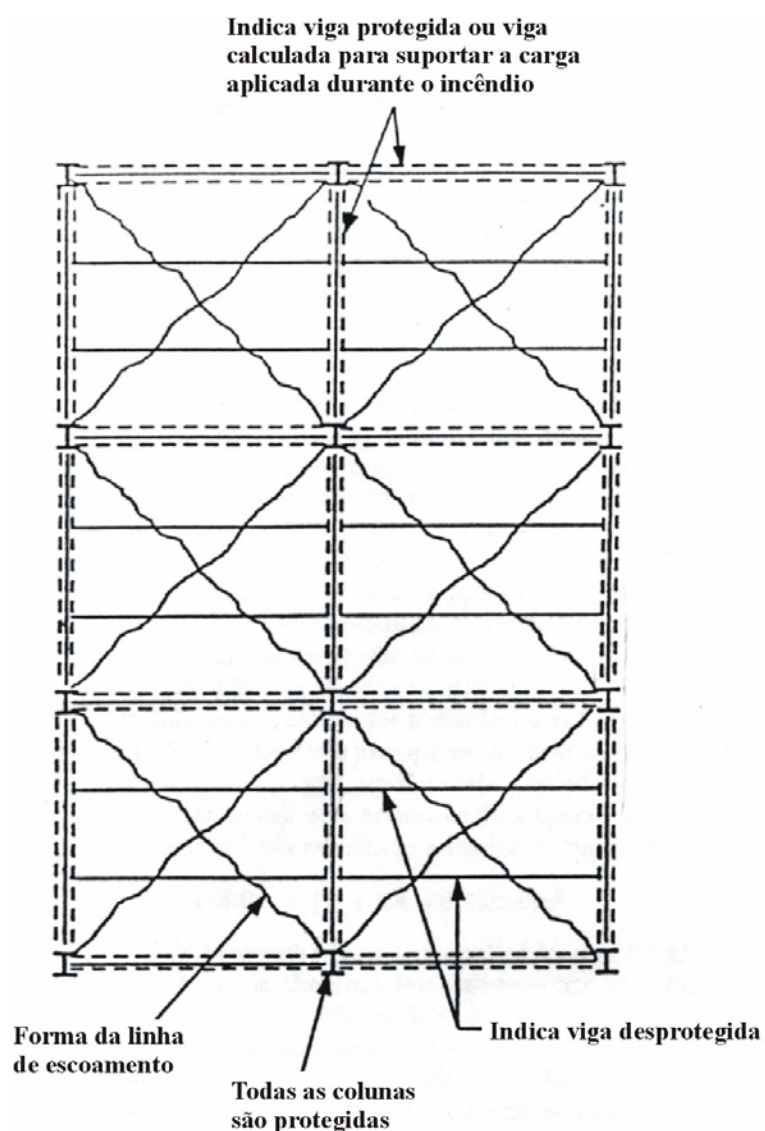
Painel de laje de 9m x 9m com proteção apenas nas vigas principais
